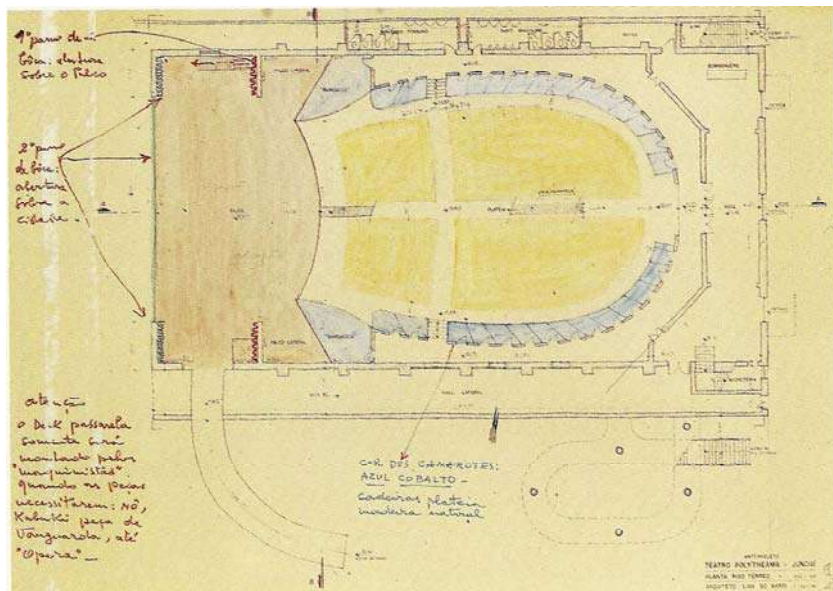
Proposta de Lina Bo Bardi para o pavimento térreo.
